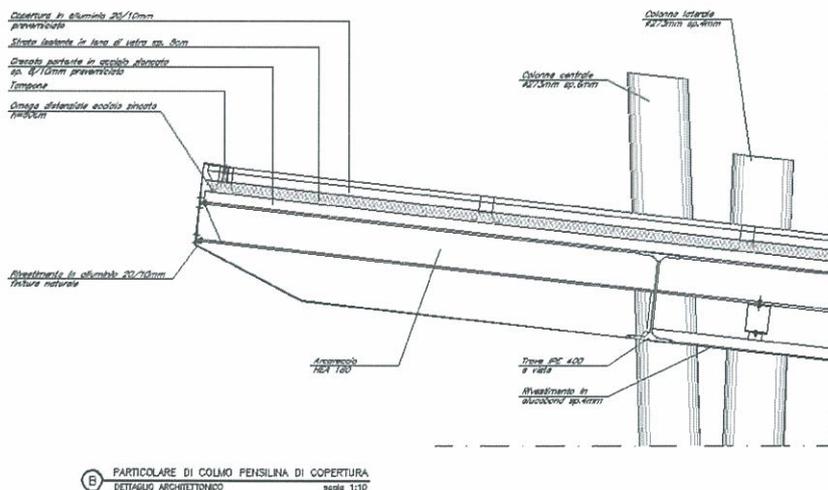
Sezione sulla copertura ingressi – dettaglio della cornice perimetrale sagomata in alluminio
